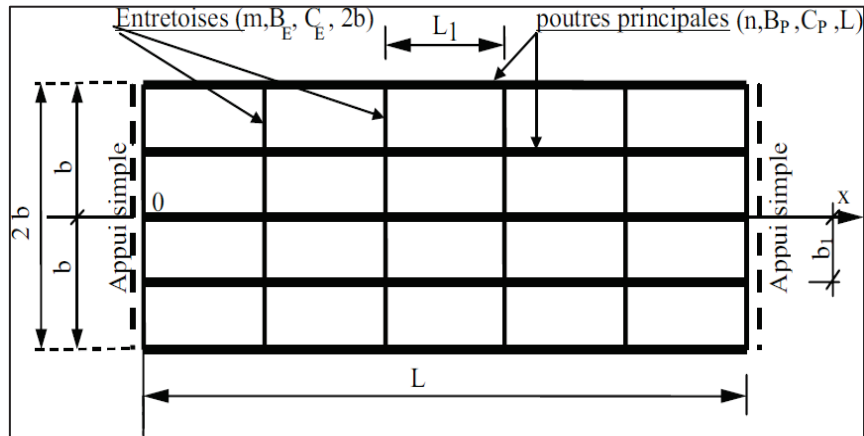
ILLUSTRATION D'UNE POUTRE ET DES ENTRETOISES.
